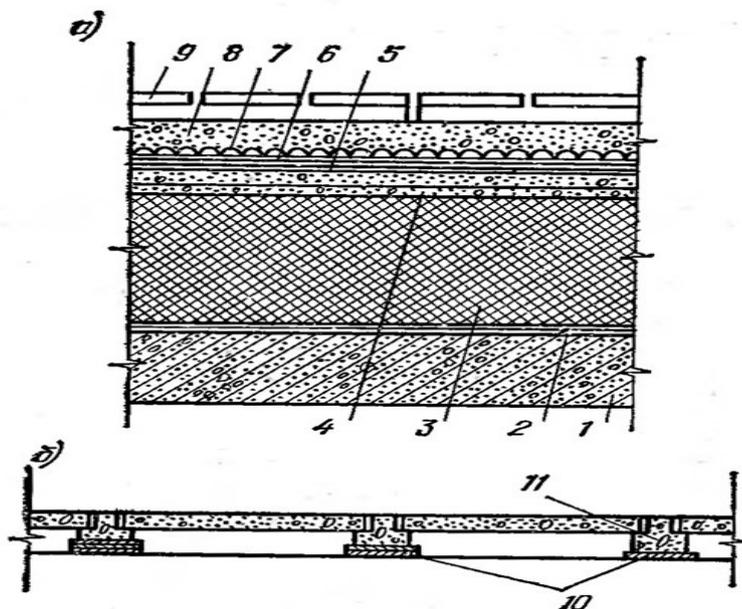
Конструктивная схема бесчердачной плоской крыши: *a* — с дренирующим слоем; *б* — без дренирующего слоя; *1* — железобетонная плита; *2* — пароизоляция, слой гидроизола; *3* — теплоизоляция — пенобетон; *4* — бетонная стяжка, армированная сеткой 200x200 мм из стальной проволоки диаметром 4 мм; *5* — грунтовка битумной эмульсией; *6* — гидроизоляция (4-5 слоев гидроизола); *7* — гравий, втопленный в битумную мастику; *8* — слой гравия толщиной 60-70 мм; *9* — керамический плитки на бетонных плитах; *10* — асфальтовые маяки; *11* — железобетонные подкладки.
